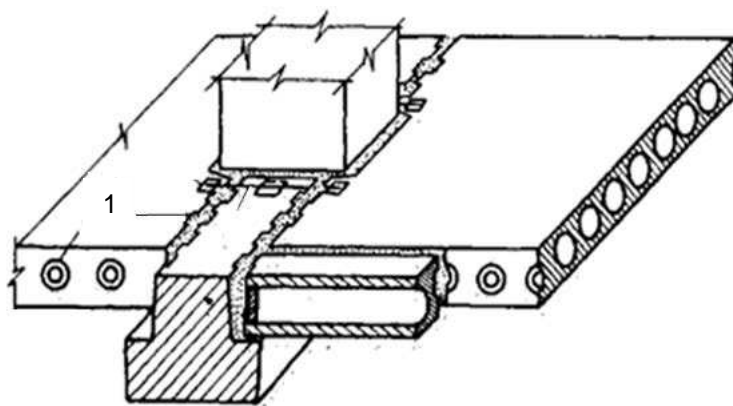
Фрагмент перекрытия связевого каркаса серии 1.020-1/83;
